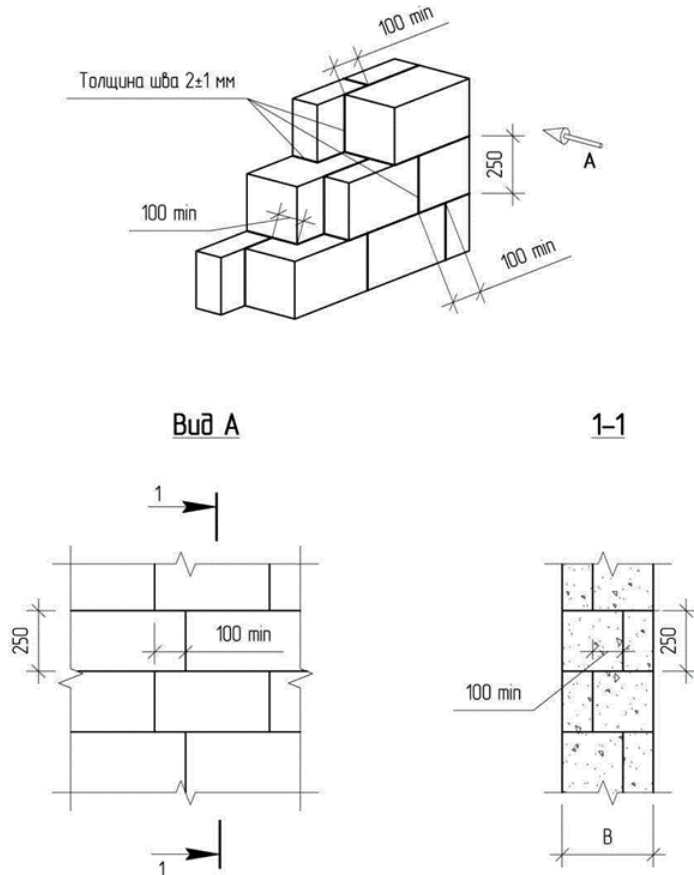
Схема кладки стен толщиной в два разных по толщине блоков
